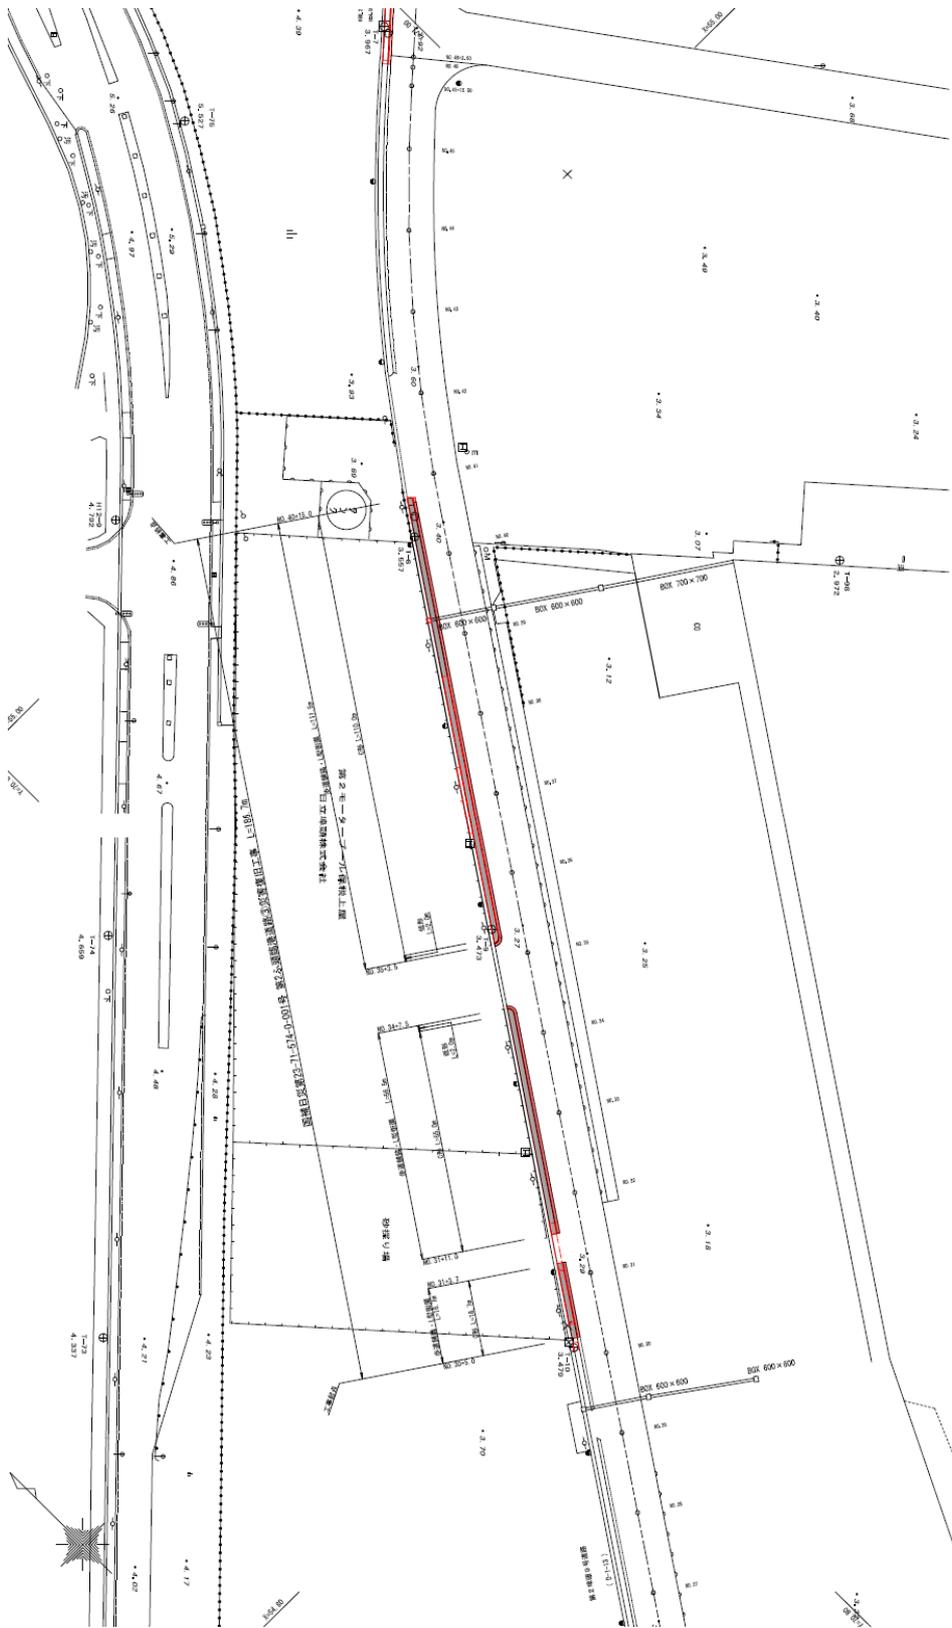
No.5 日立港区_第2埠頭9号道路の平面図(復旧後)
